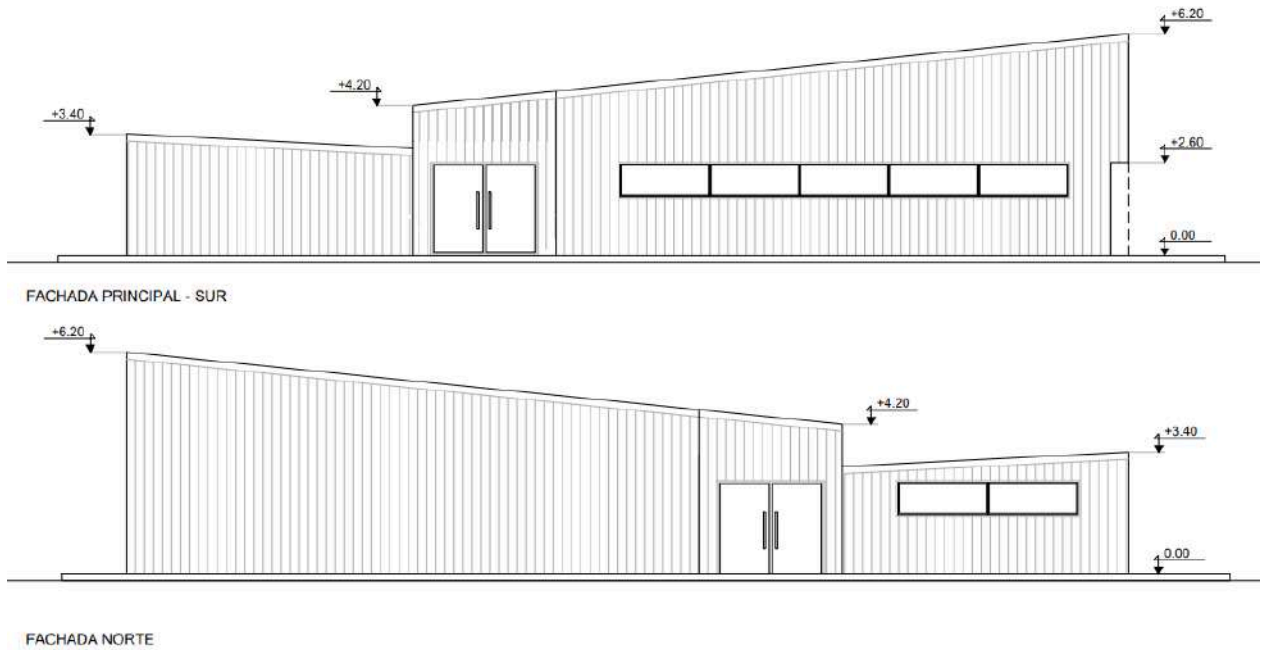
Fachadas Norte y Sur Centro Recreativo.
